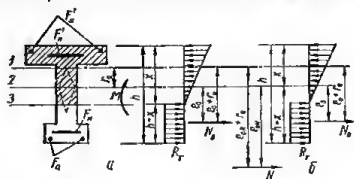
Схема внутренних усилий в сечении предварительно напряженного элемента при расчете по образованию трещин зоны, растянутой внешней нагрузкой:
